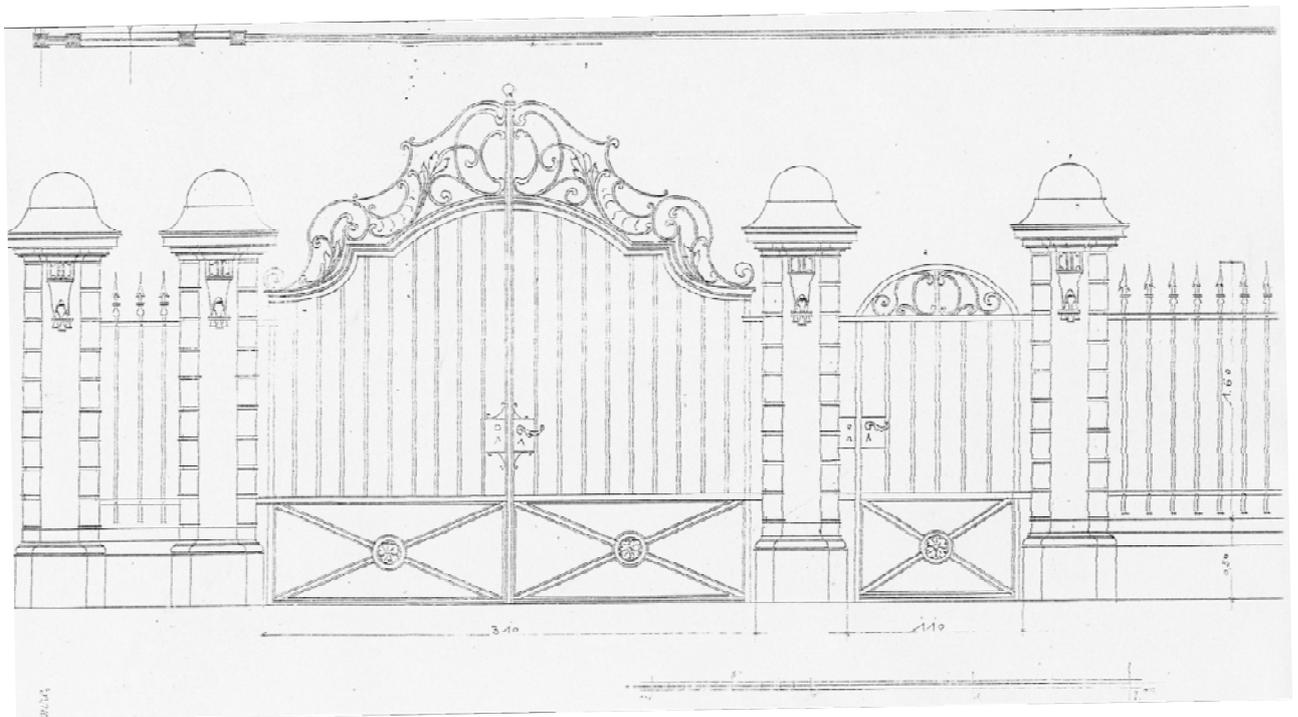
H. Plange, Planzeichnung der Einfriedigung zur Straße, 1904
